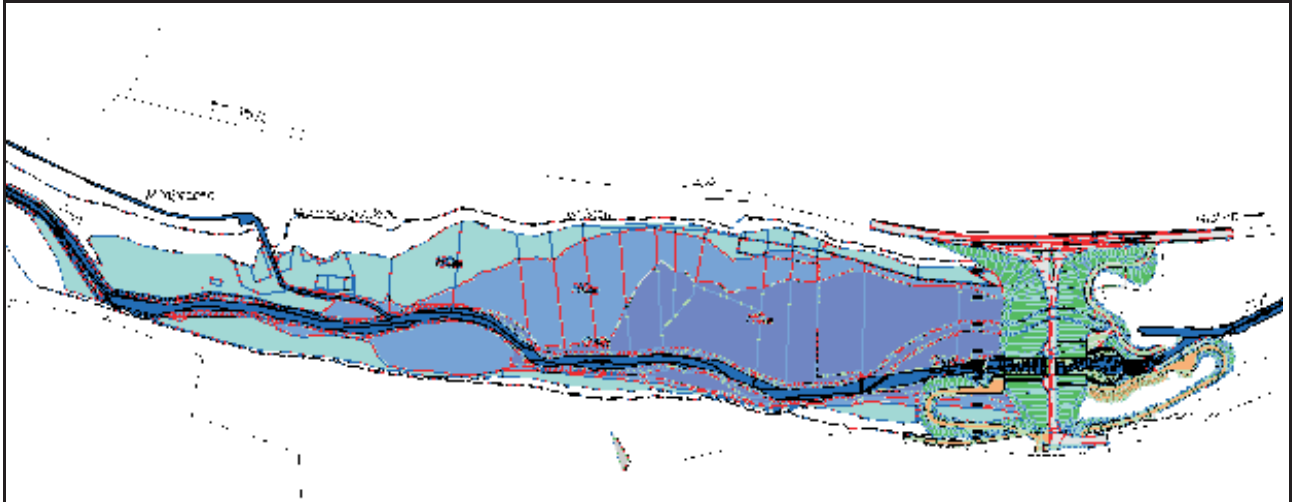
Lageplan des HRB Glatt / Hammerschmiede mit Einstafläichen
